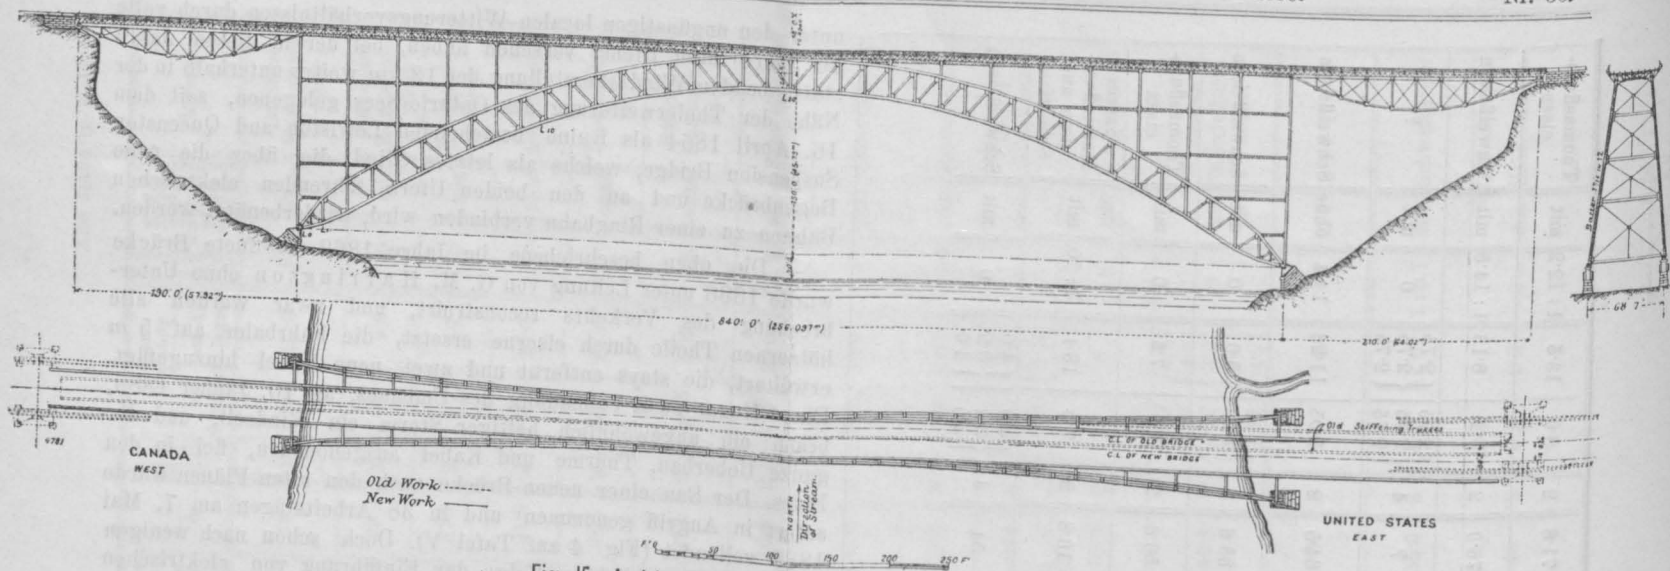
Ansicht, Lageplan und Querschnitt der neuen Brücke.
